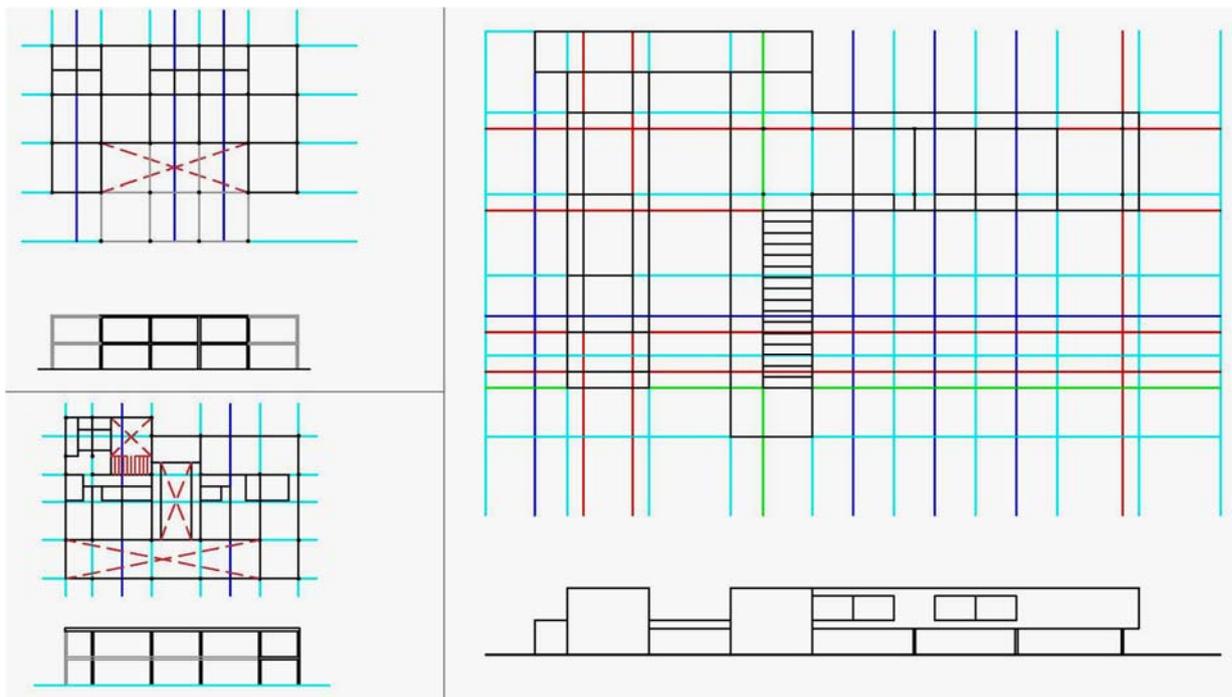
redenho de planta baixa e fachada com a modulação: Residência WS, NT e CT. Fonte: desenho da autora
